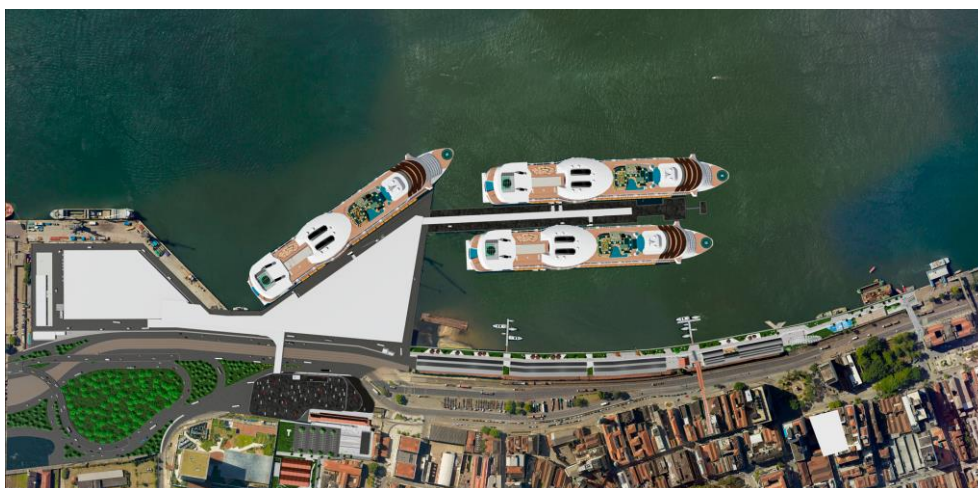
Pier de atracação. Fonte: EVTEA Concais.
